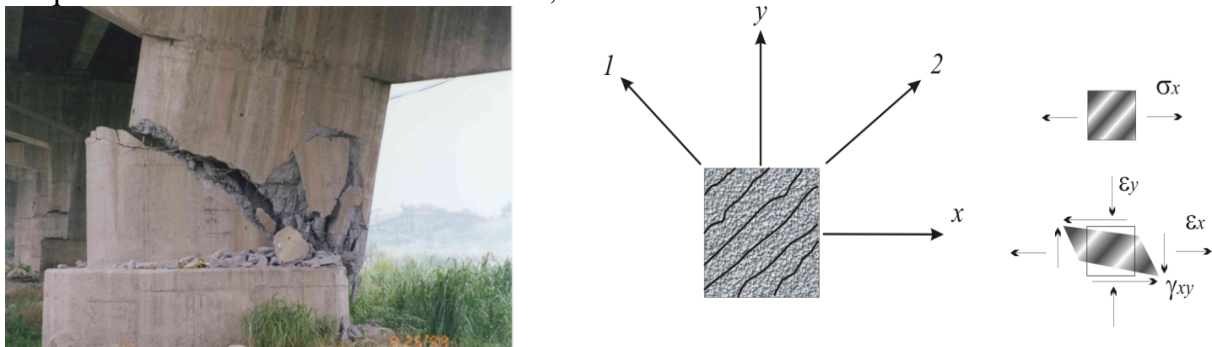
Rotura a cortante por solicitaciones sísmicas y mecanismo anisótropo del hormigón fisurado
